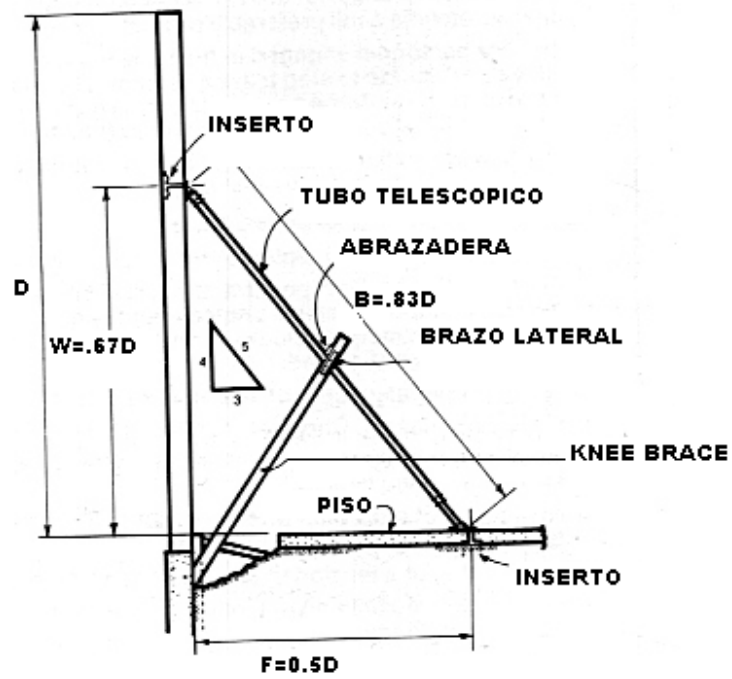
d Colocación de tubo telescópico en vista lateral.
